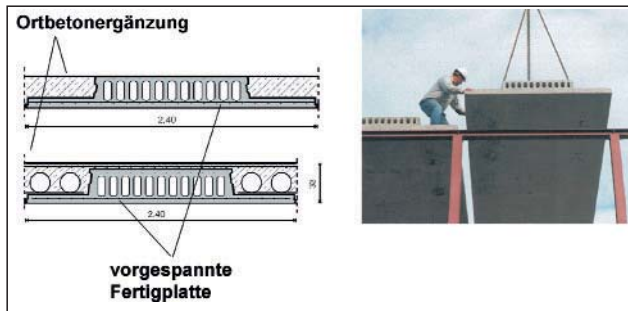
Querschnitt der Elementdecke WING mit Ortbetonergänzung [15]
